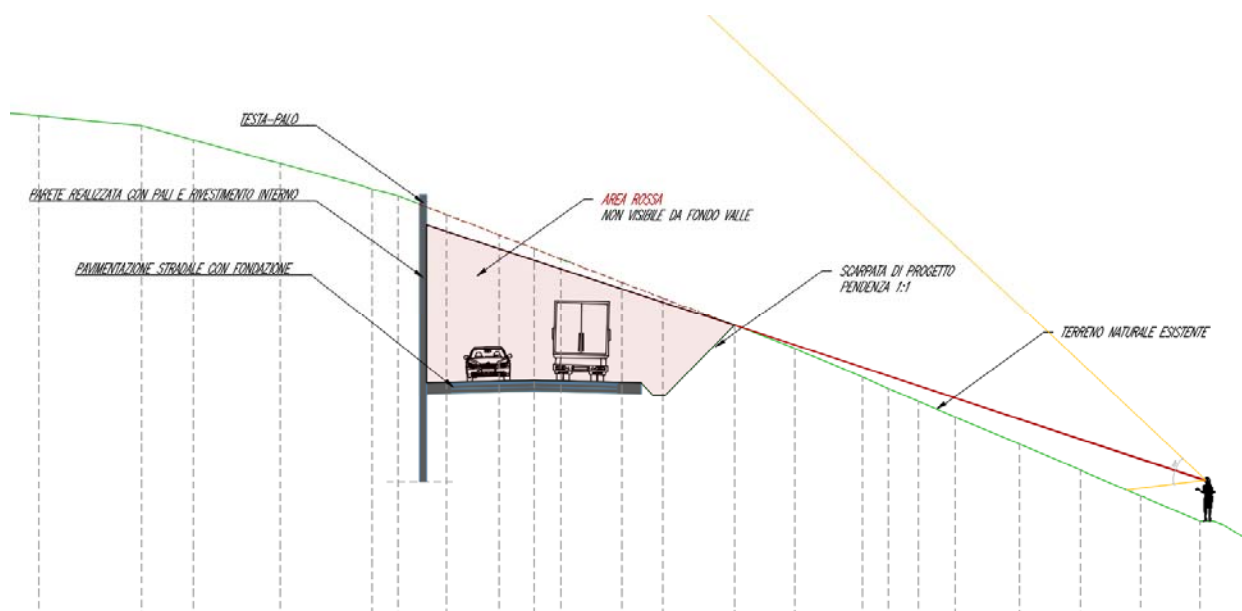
Sezione trasversale della strada, riportata anche nel foto-inserimento seguente
